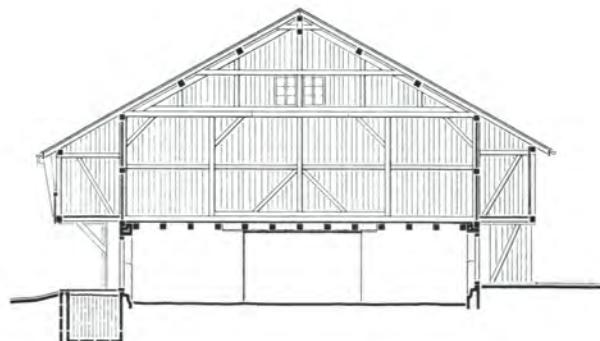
Coupe transversale sur la travée des étables avant transformation.
